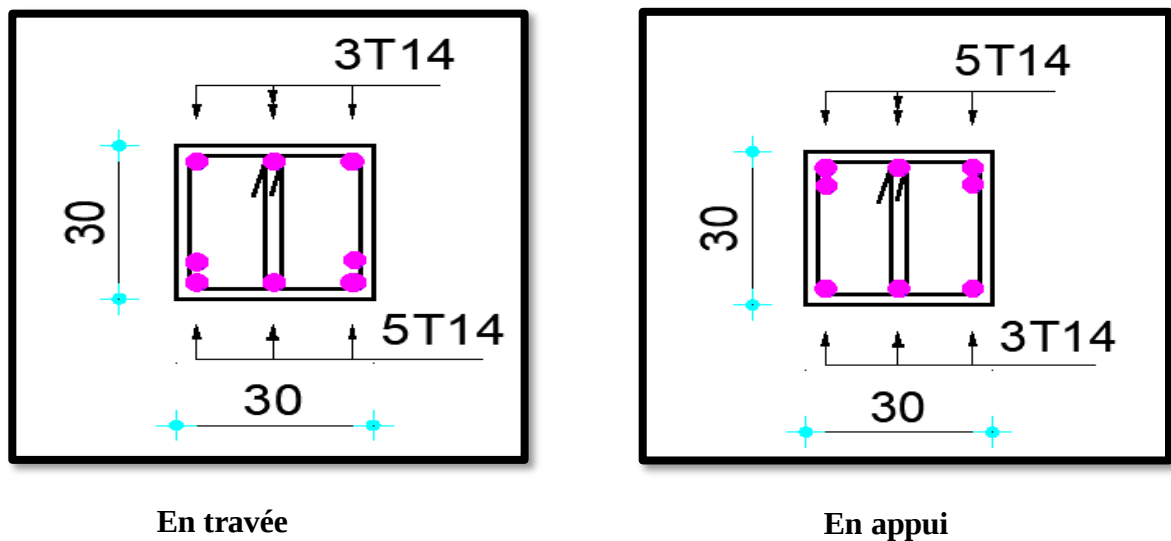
Croquis du ferrailage de la poutre secondaire.
